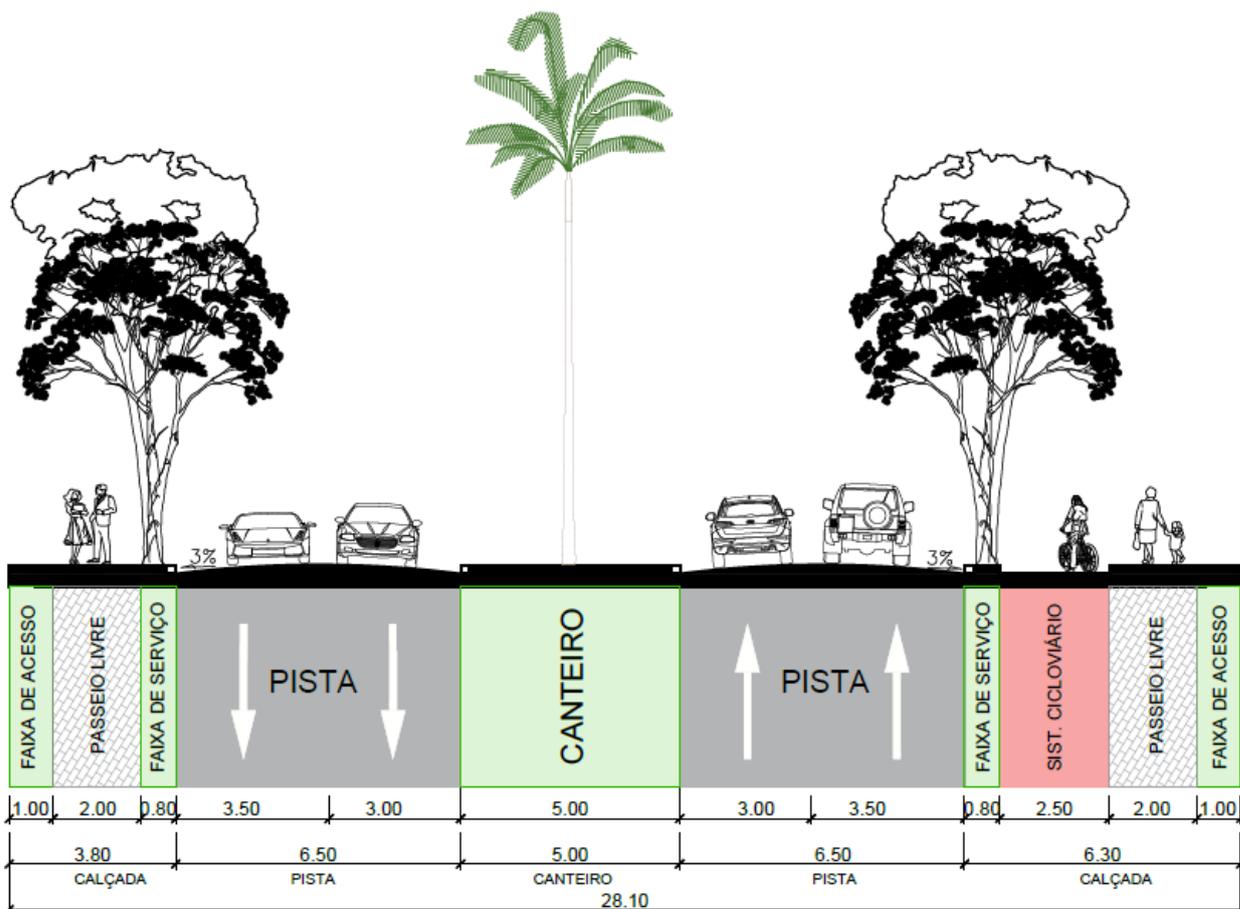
Perfil 01 – Avenida Buritizal (entrada do parcelamento)
